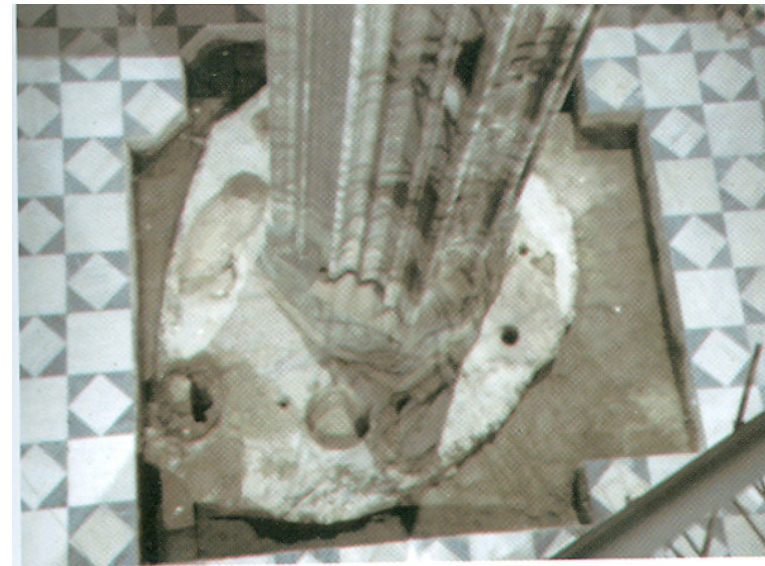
Cimiento de pilar del Trascoro. Excavación 2000
